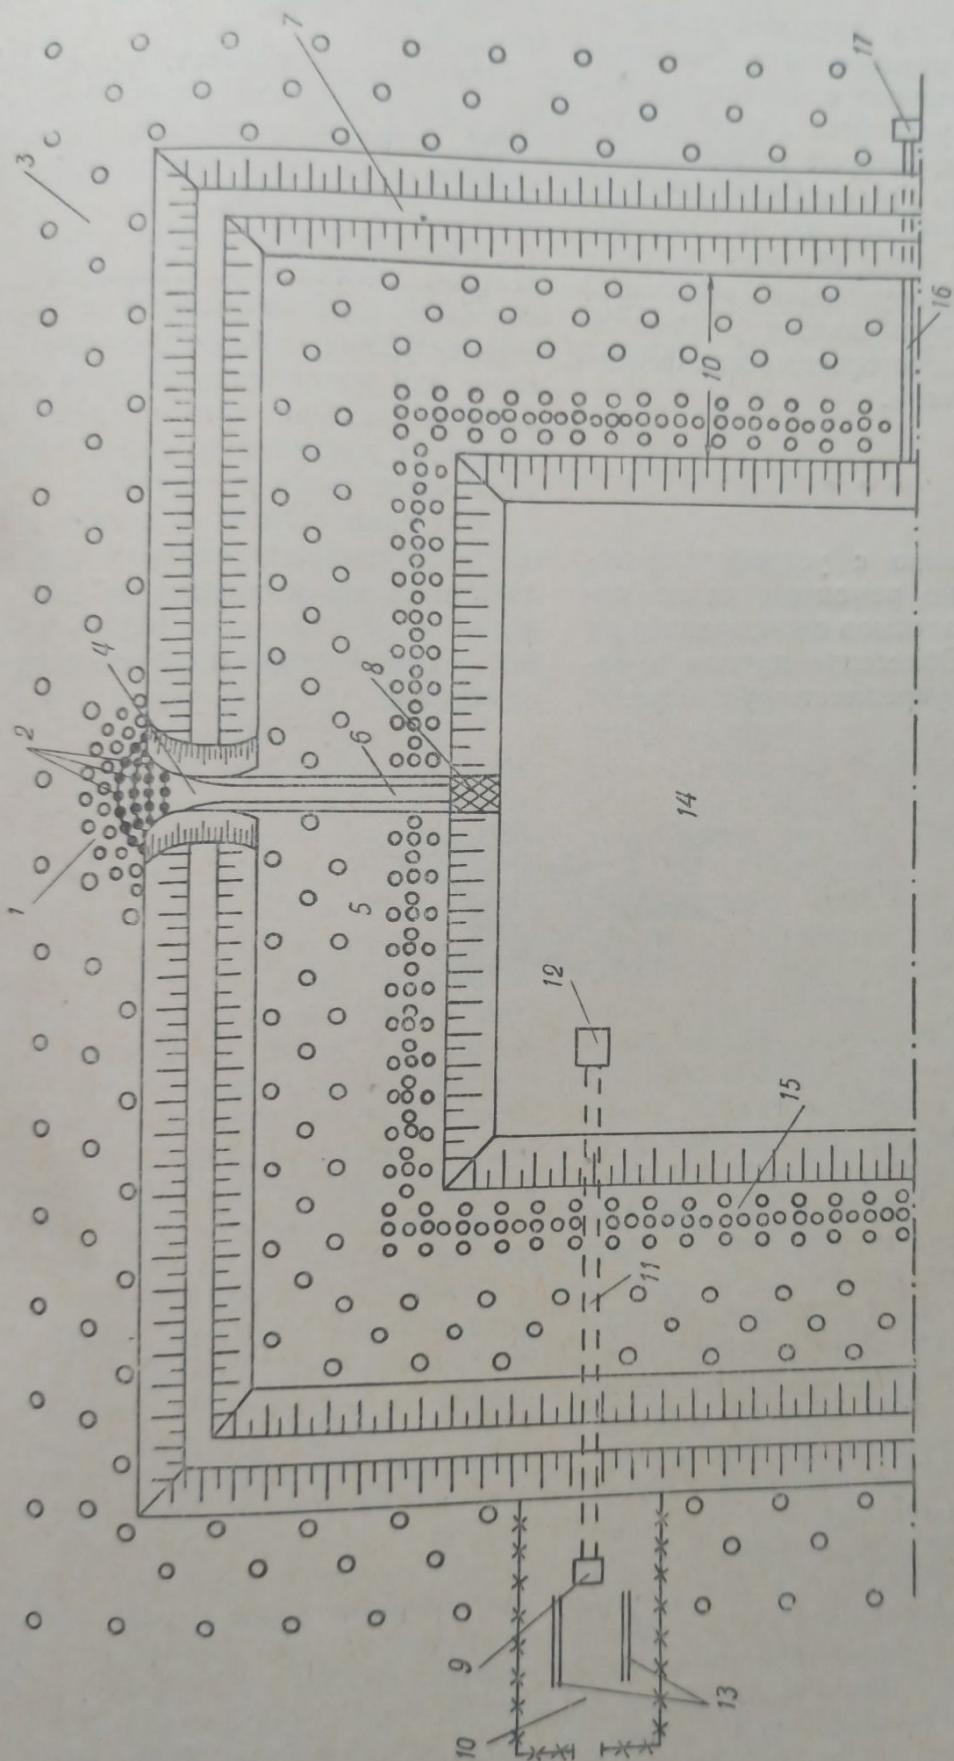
План котлована с водоприемными и водозаборными устройствами.
